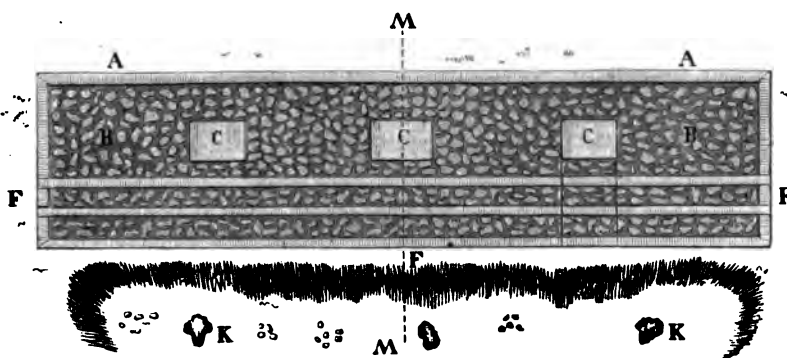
Plan af terrassen, jfr fig. 13 och 14. Efter La Pérouse.
